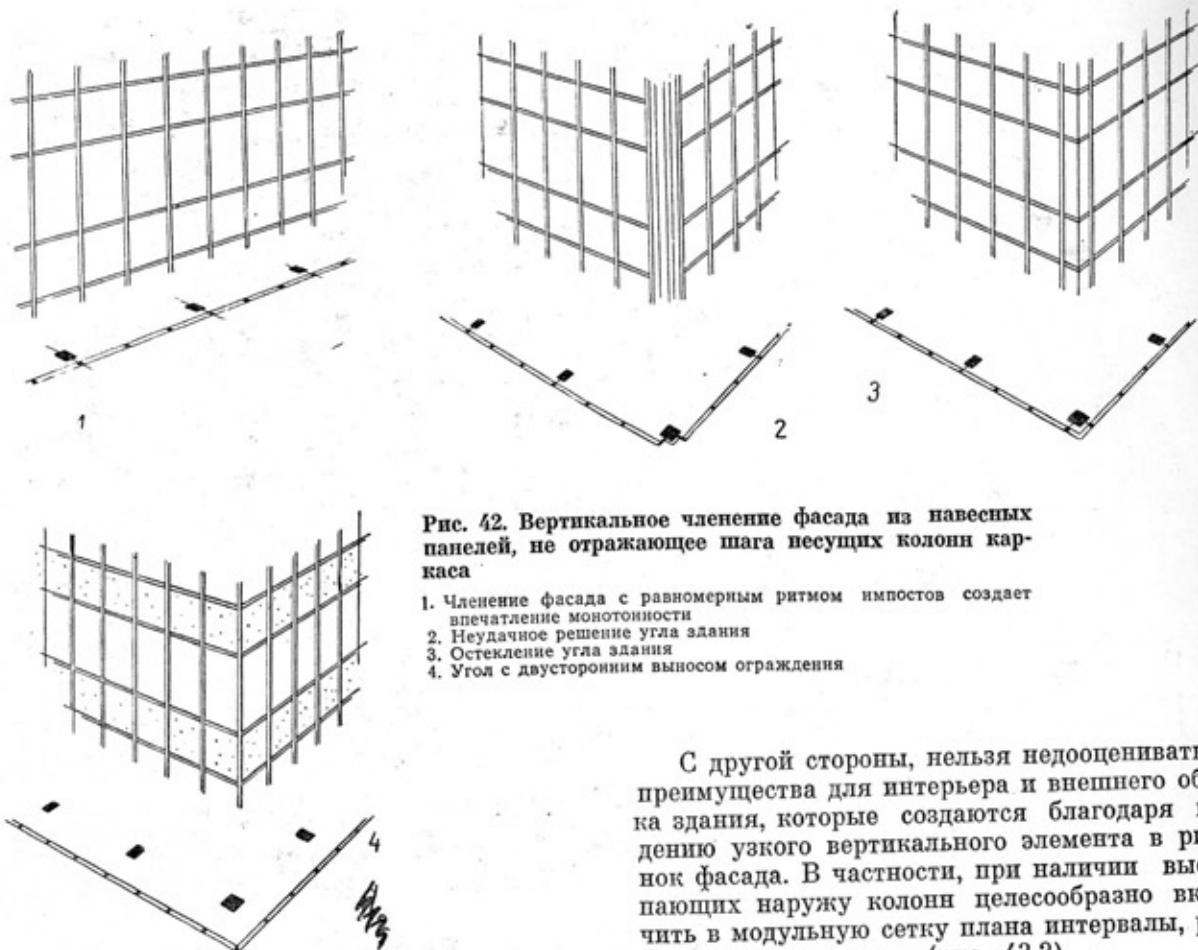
Вертикальное членение фасада из навесных панелей, не отражающее шага несущих колонн каркаса
